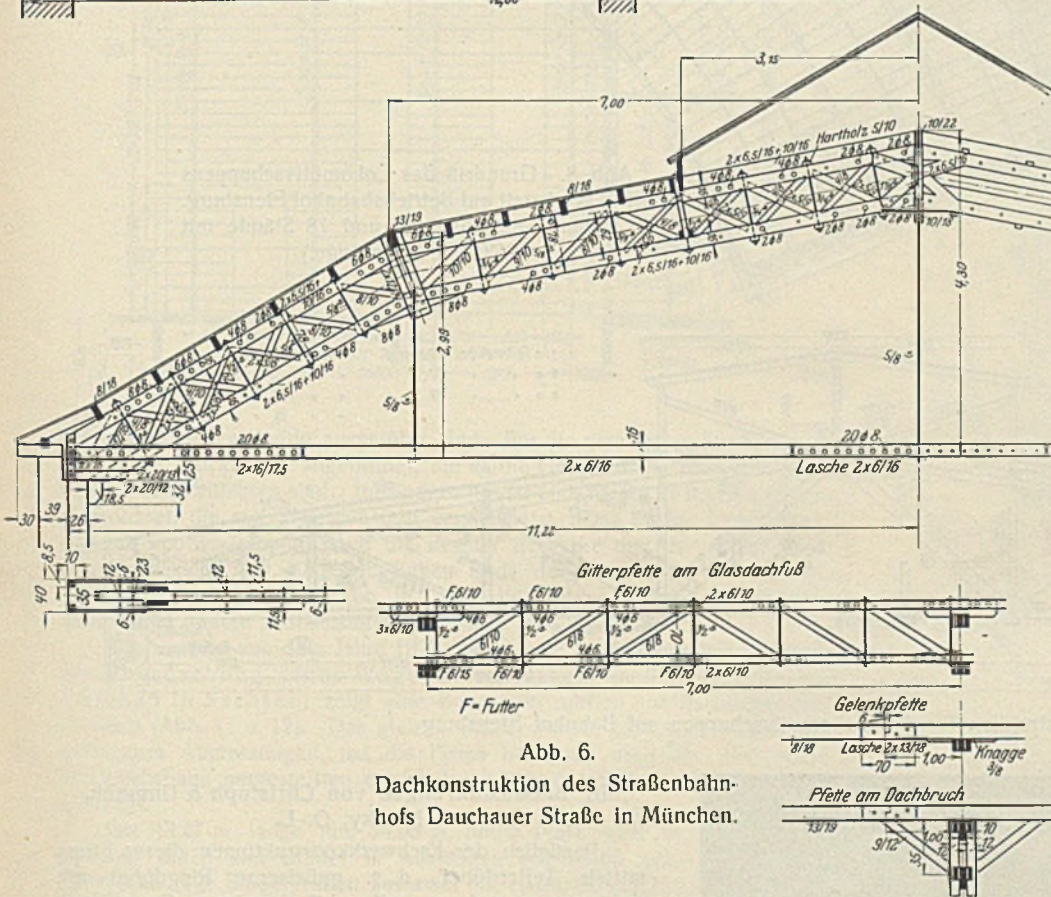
Dachkonstruktion des Straßenbahnhofs Dauchauer Straße in München.
